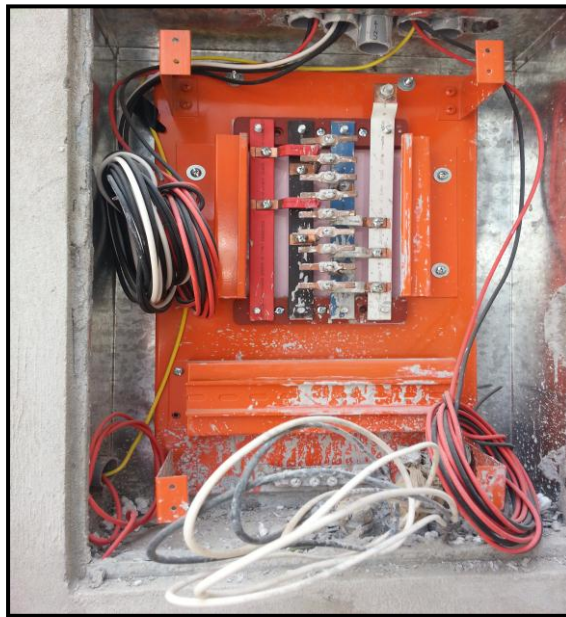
FOTO PROYECTO L. Tablero de distribución en estado de suciedad.
